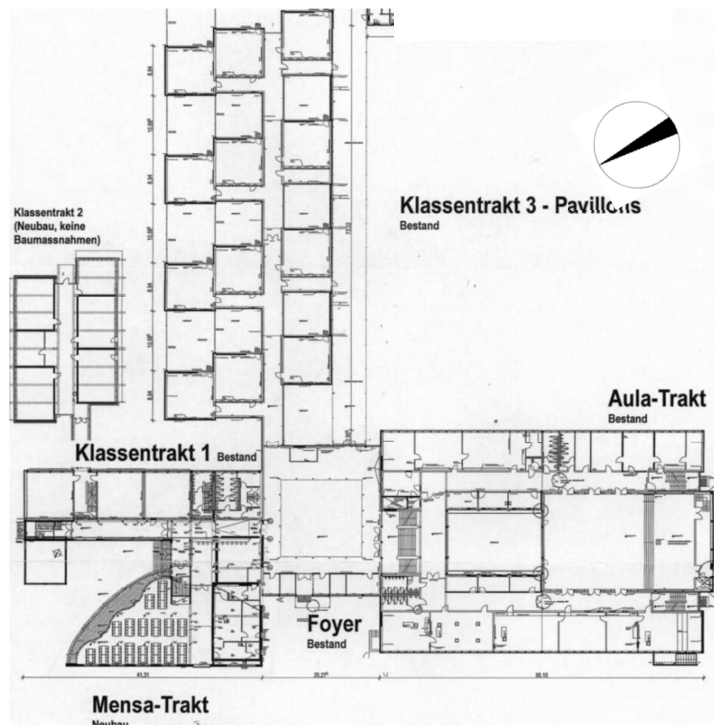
Grundriss EG Gymnasium Elsa-Brändström
